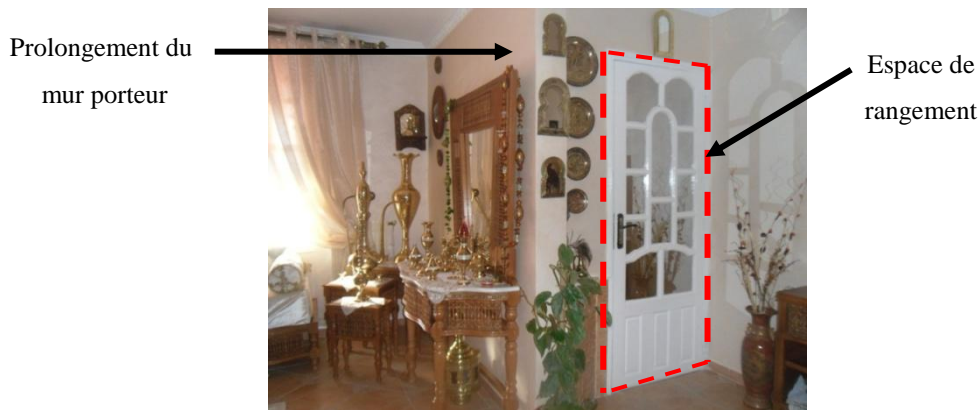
Prolongement du mur porteur et création d'un espace de rangement
